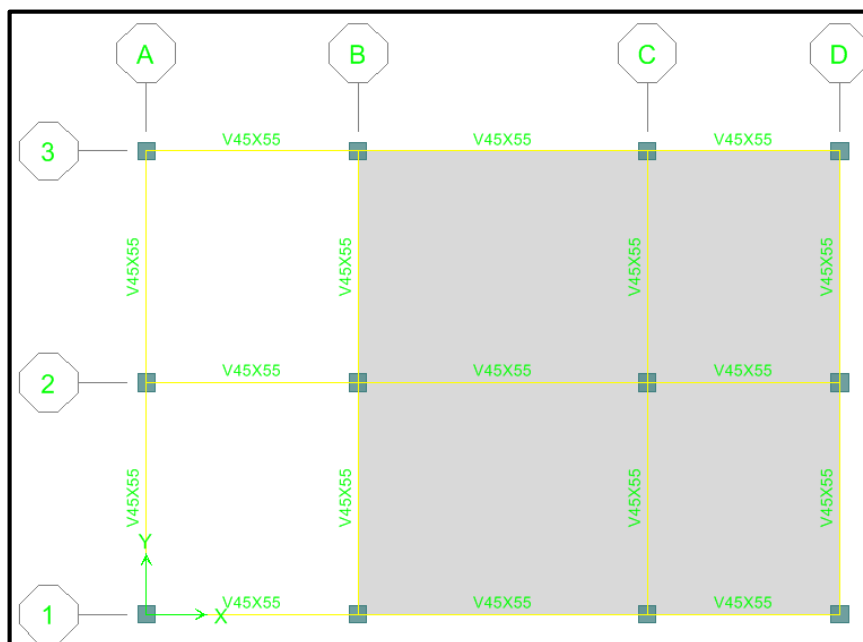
Secciones Finales de Vigas (Nivel 1 y 2)
